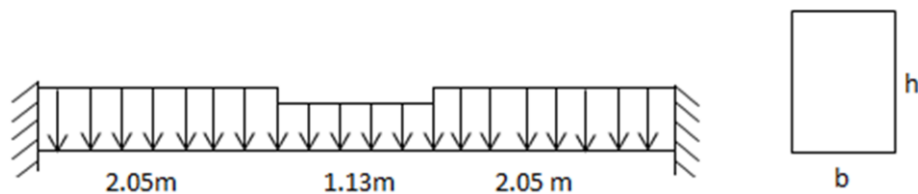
Schéma Statique de la poutre brisée (escalier type 01)
